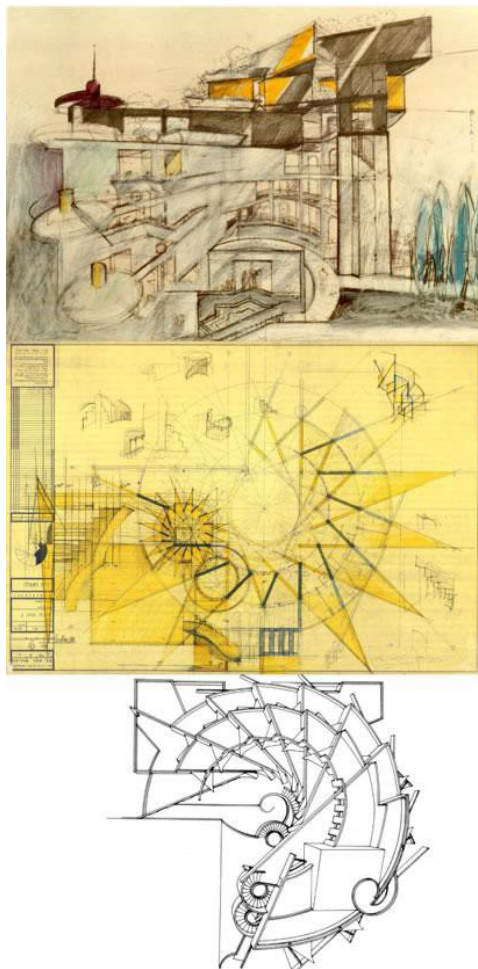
Spiral Apartment House (1984-1989) Bocetos de alzado y planta. Fuente: http://www.zvihecker.com/projects/project_titel-30-1.html#4
